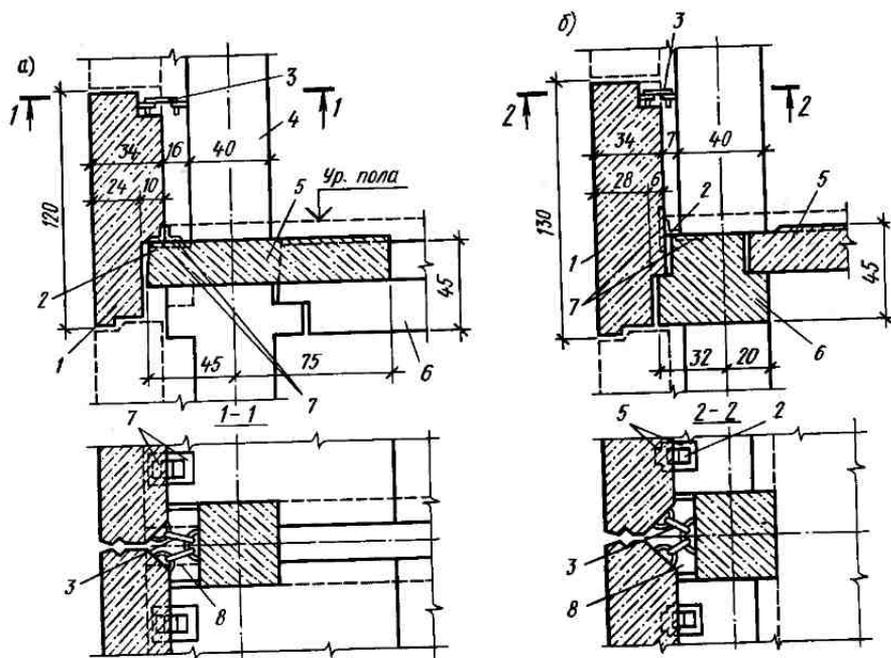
Опирание наружных стеновых панелей каркасных зданий:
